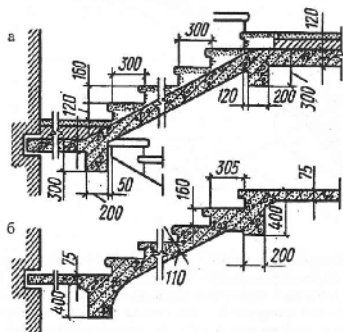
Конструктивные решения монолитных железобетонных лестниц: а — со ступенями, опирающимися на предварительно выполненную несущую плиту; б — конструкция, изготовленная одновременно с несущей плитой и ступенями лестницы
